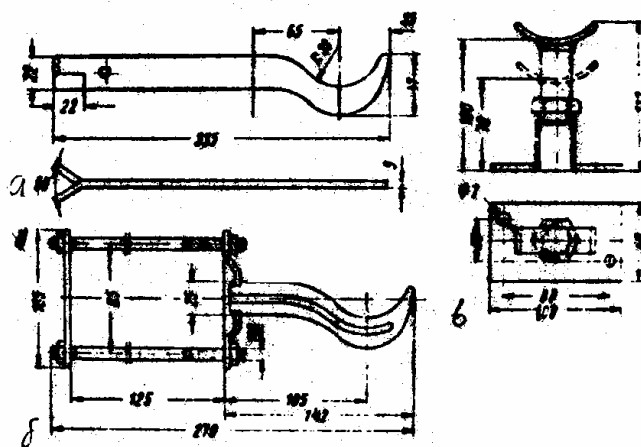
Кронштейны и подставки для крепления и установки радиаторов: а – обычный кронштейн; б – кронштейн для крепления на сквозных болтах; в – подставка (регулируемая)
